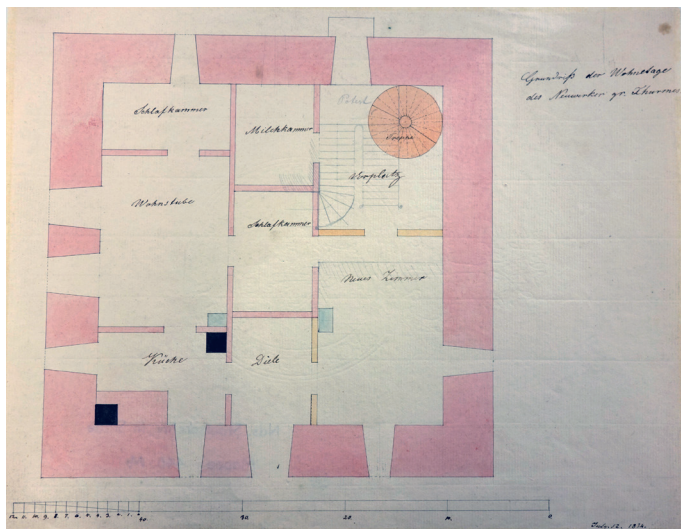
Grundriss E2, 1834 (NLA ST, Mappe 0446)
